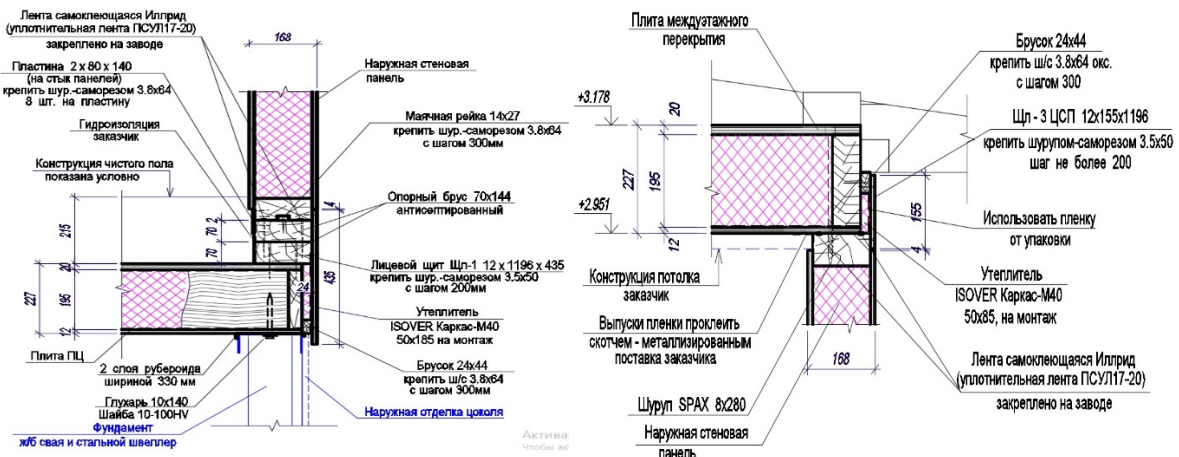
Узлы примыкания стеновых панелей с цокольными и междуэтажными перекрытиями
